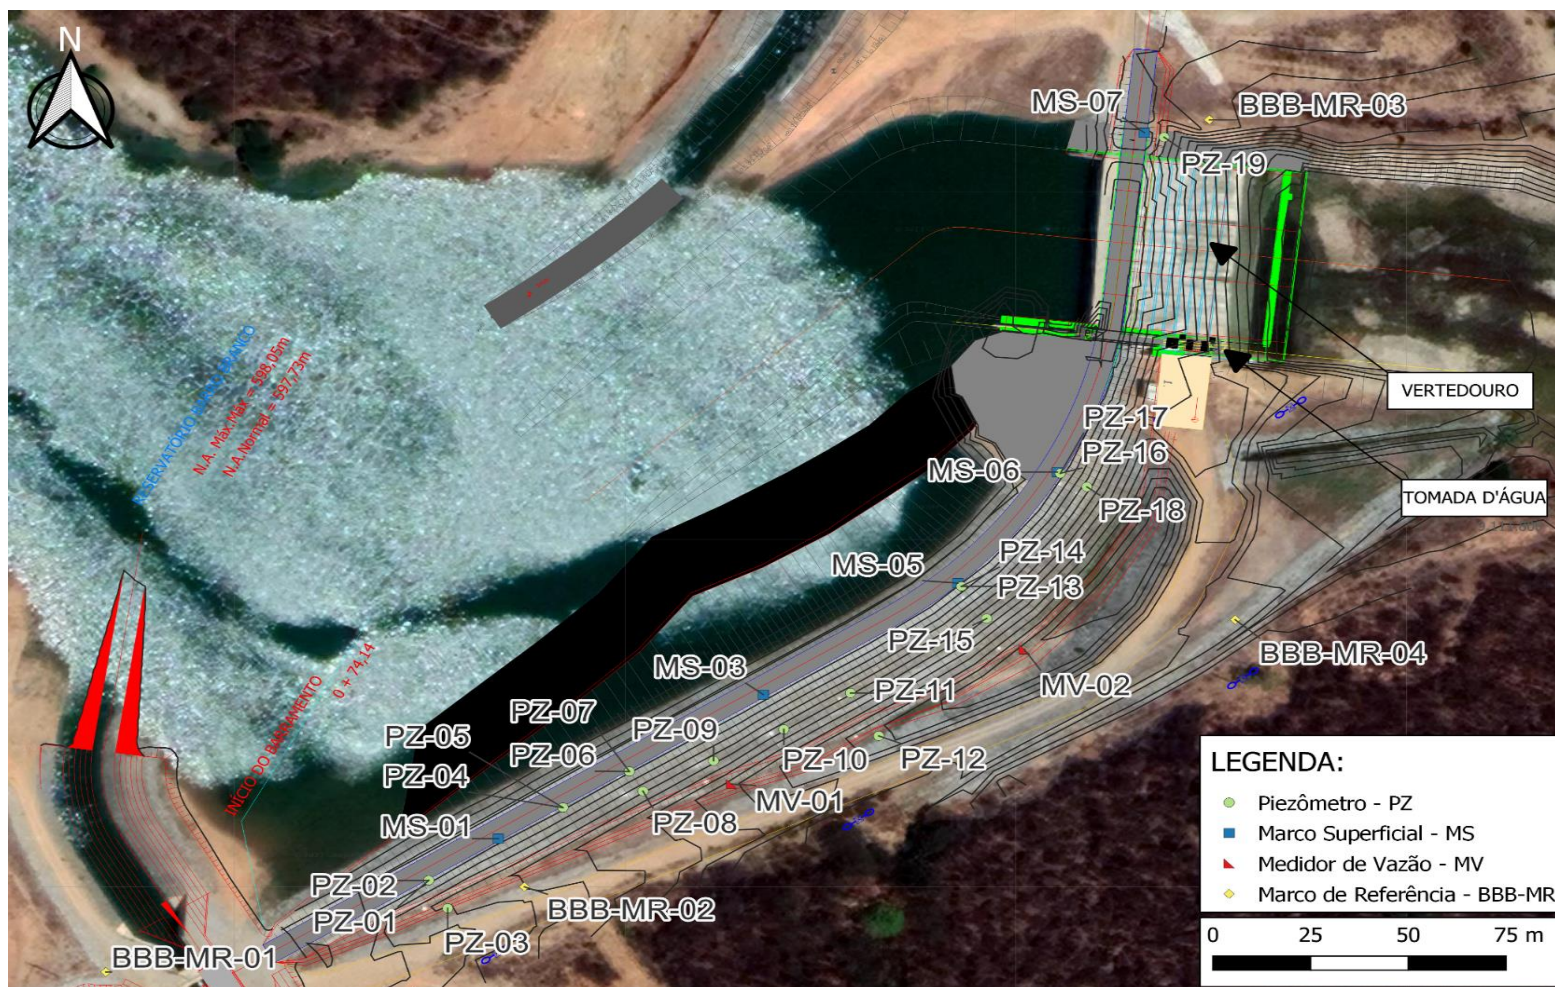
Planta de localização da Instrumentação da Barragem Barro Branco. Fonte: Projeto "As built" n.º 1352-ASB-2115-00-00-001-R01 modificado/Google Satélite DATUM SAD 69.
